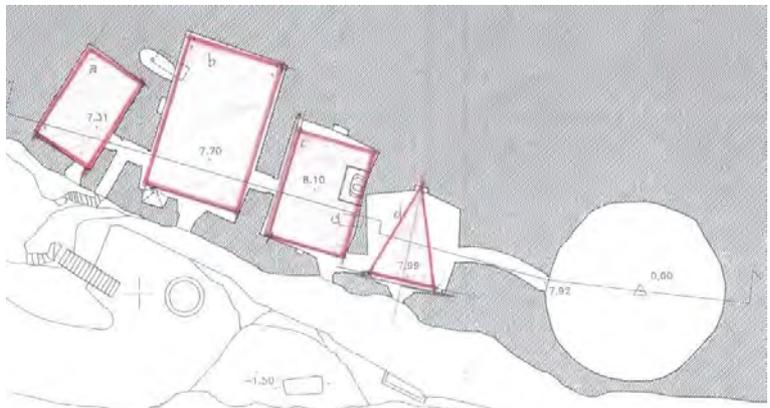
Gurfa. Pianta piano superiore con “geometria aurea” sovrapposta
